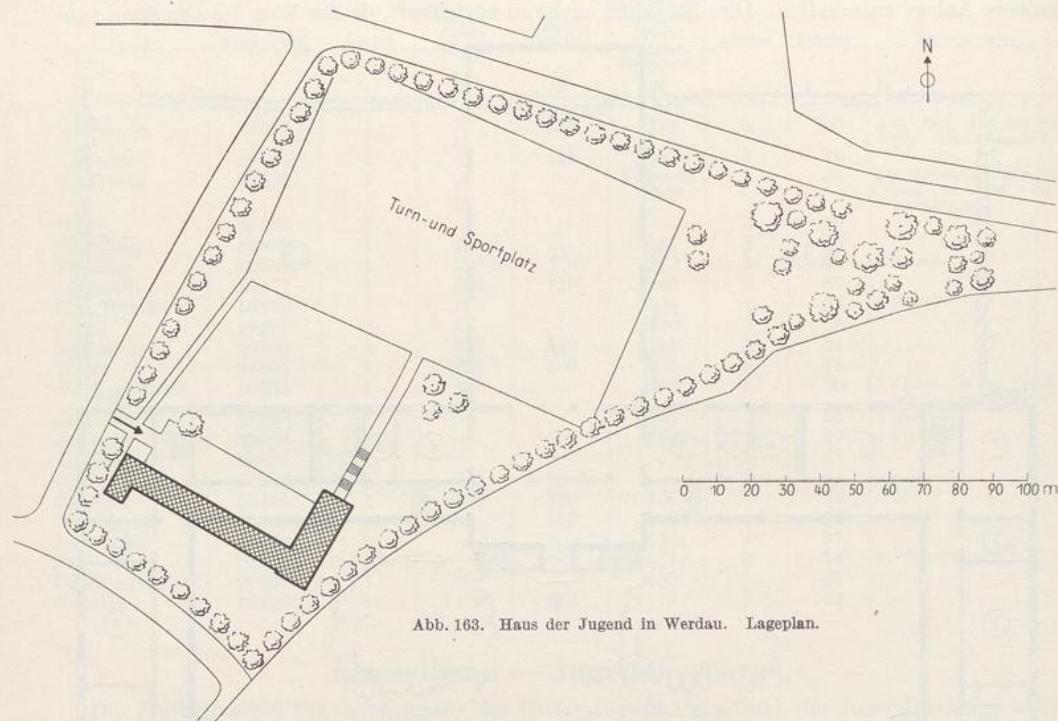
Haus der Jugend in Werdau. Lageplan.
